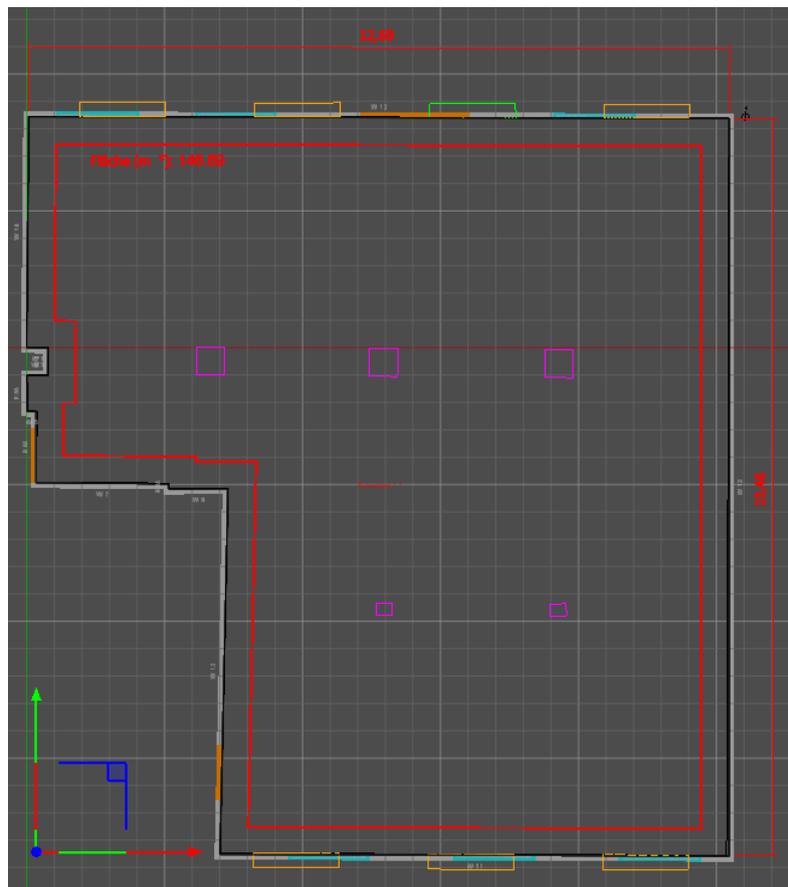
Screenshot des Relux-Modells mit importiertem Grundriss
